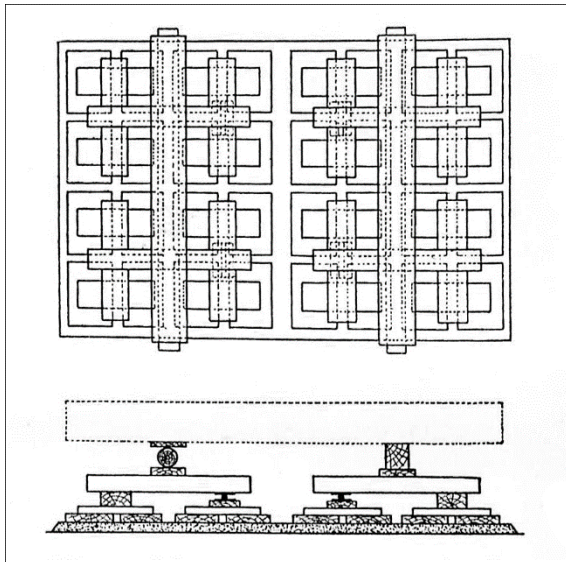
Deckenbelastungsschema über dem Erdgeschoss der Häuser III und IV⁹⁹
